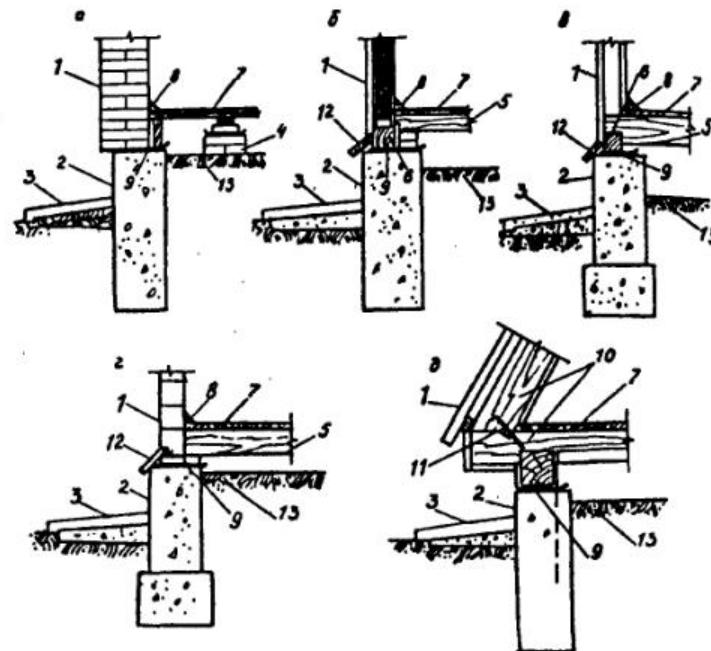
Цоколь: а — под кирпичные стены; б — под деревянные панельные стены; в — под каркасные стены; г — под бруscатые (бревенчатые) стены; д — под стены «Шалаши». 1 — стена; 2 — фундамент; 3 — отмостка; 4 — кирпичный столбик; 5 — балка перекрытия; 6 — брус нижней обвязки; 7 — доски пола; 8 — плинтус; 9 — гидроизоляция (2 слоя толя или рубероида); 10 — рама; 11 — анкер; 12 — отливная доска; 13 — грунт.
